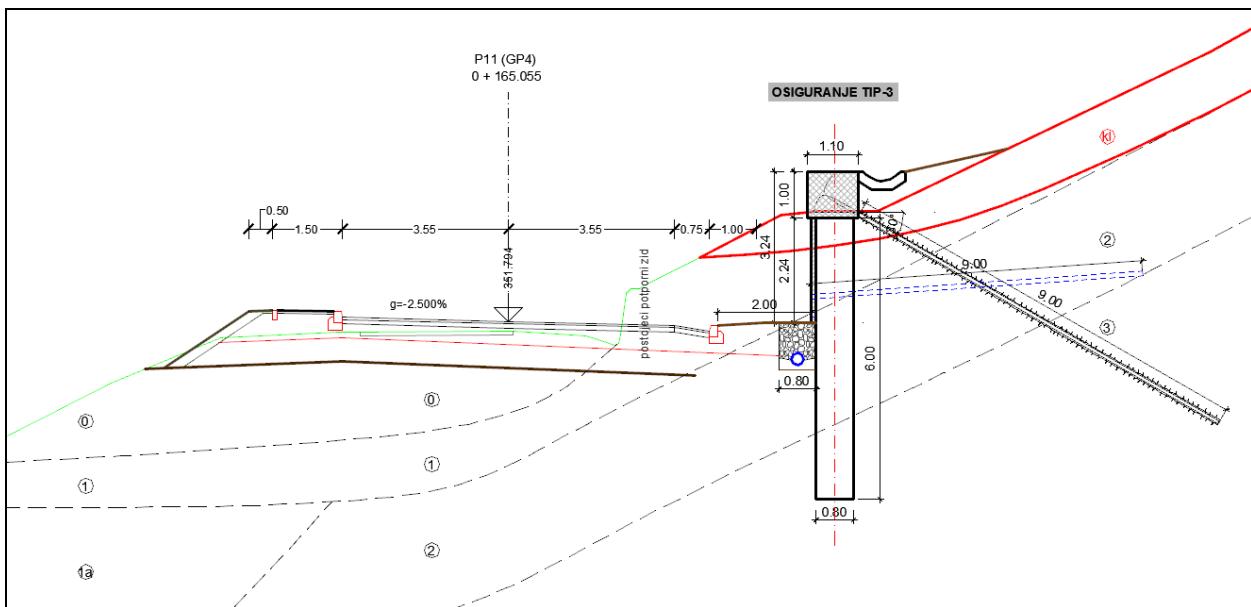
Armiranobetonski gabion za stabilizaciju padine
